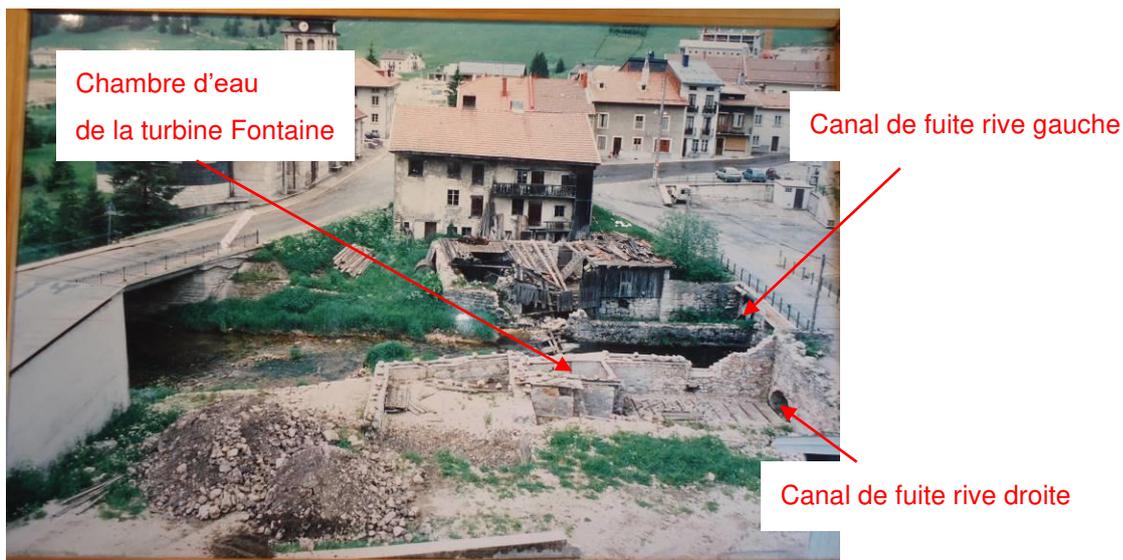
Photo du site avant reconstruction par l'association « Les gardiens de la Boissellerie », prise depuis la rive droite (Source : musée de la Boissellerie)
